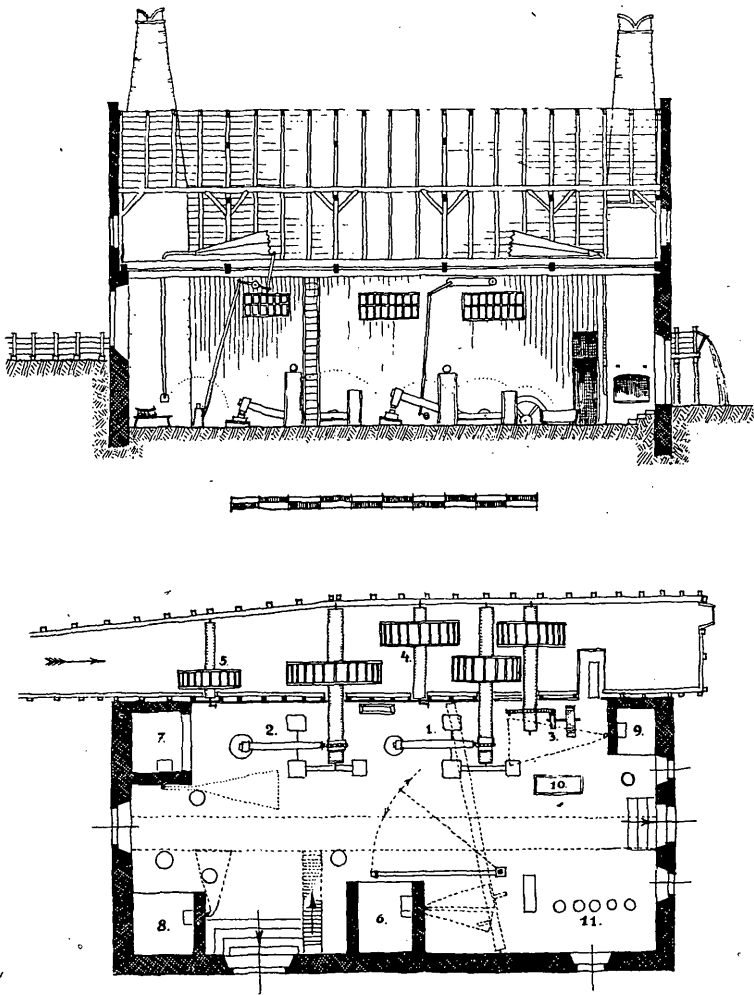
Plan des Sensenhammers im Prietal zu Leonstein, nach der Erneuerung vom Jahre 1832.
